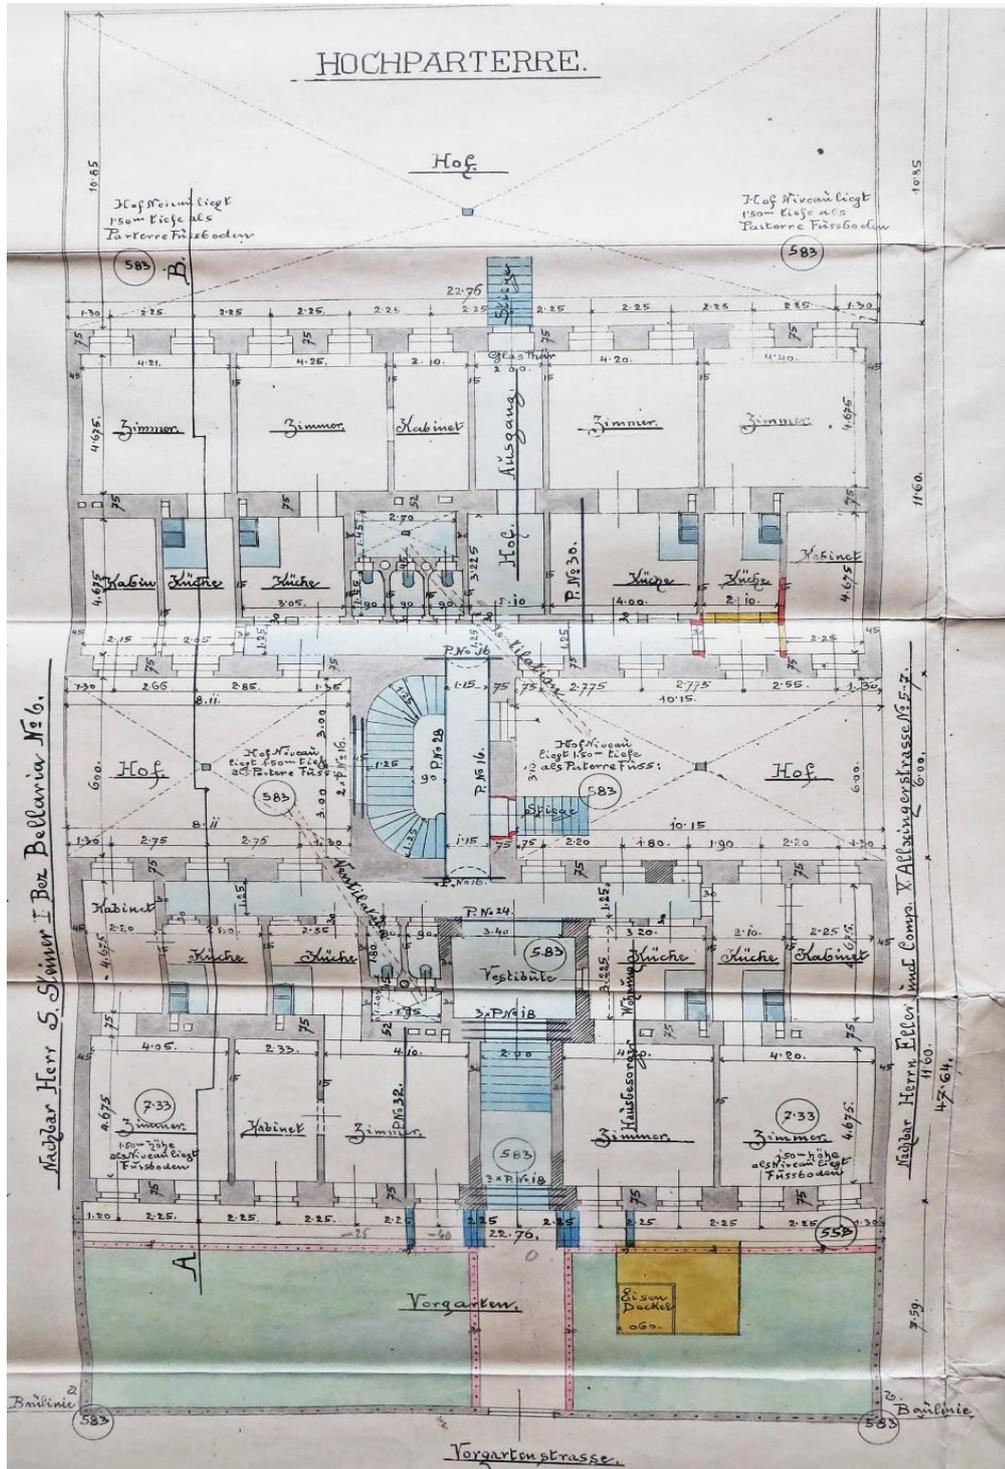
Auswechslungsplan 1906, Hochparterre, Vorgartenstr. 67, 1200 Wien
